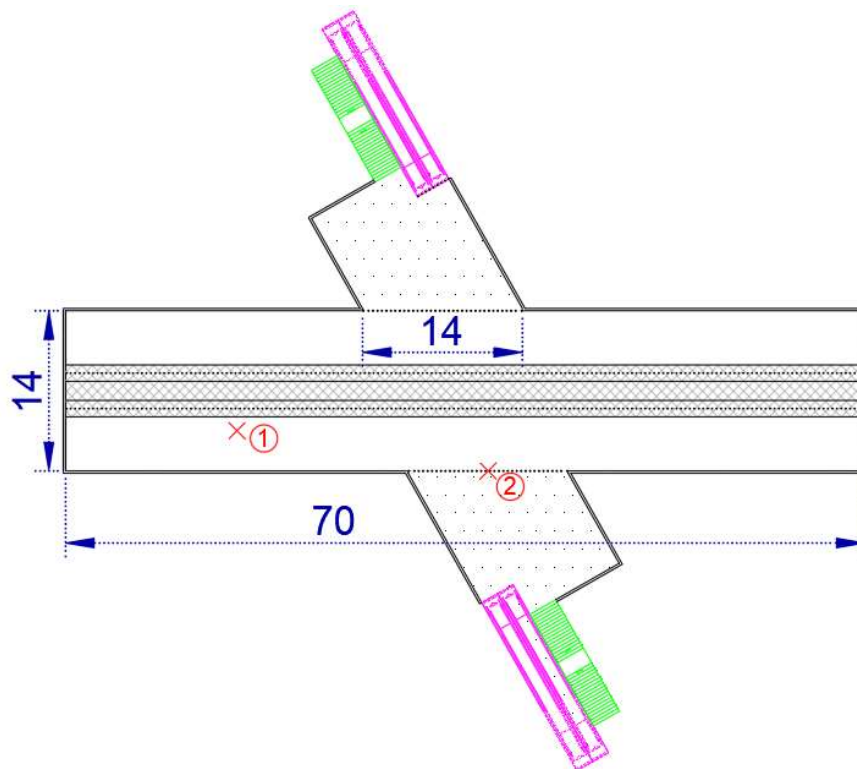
Planta da plataforma da estação Faria Guimarães com sinalização dos dois pontos utilizados para a medição do ruído de fundo (dimensões em metros)
